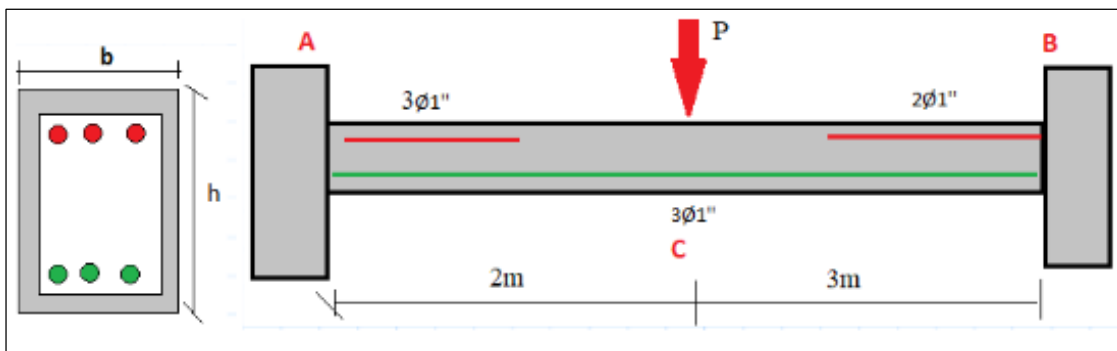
Ejemplo de aplicación-mecanismo de falla en vigas
